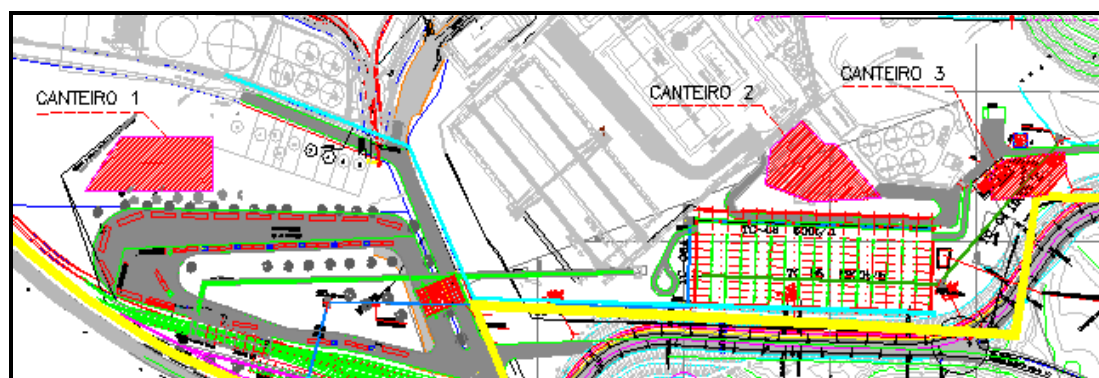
Posição dos canteiros de obras FERTIMPORT
